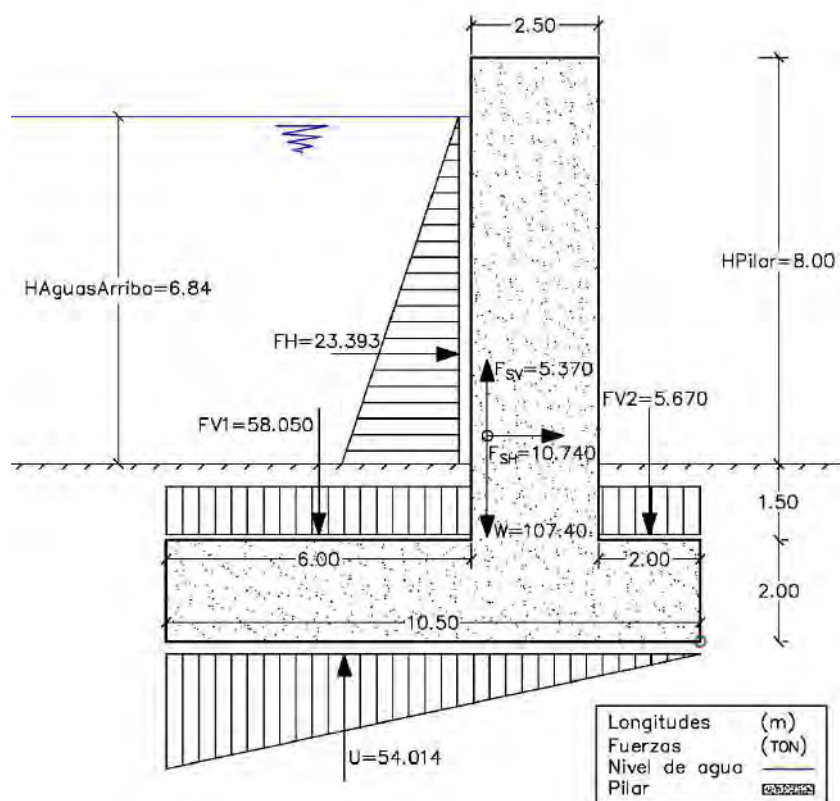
Dimensiones de pilar. Fuente: Elaboración propia.
